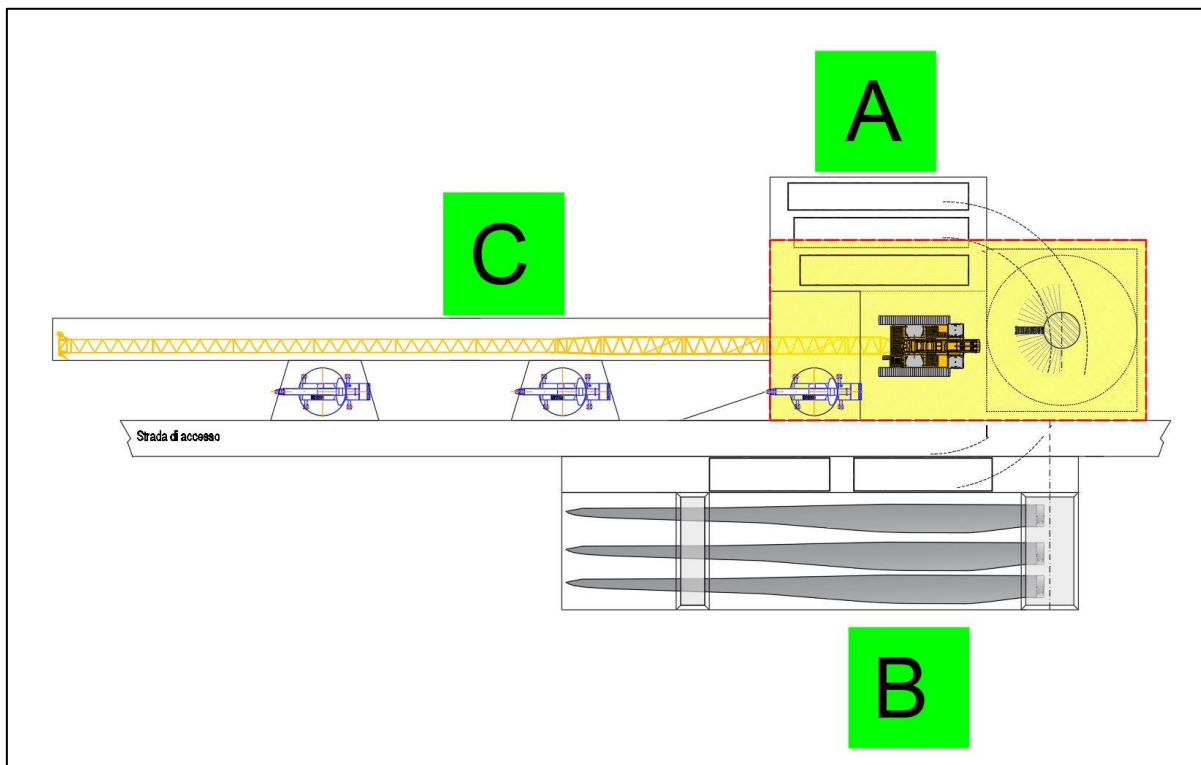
fasi di realizzazione delle piazzole di cantiere
